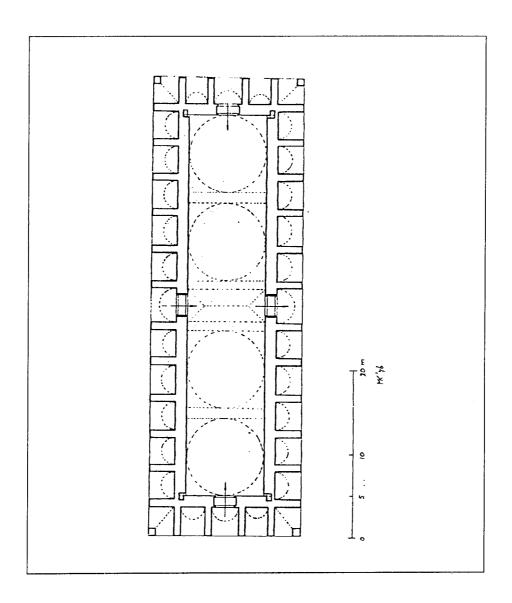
مسقط أفقي لبادستان سيريز باليونان (عن :Cezar) .
